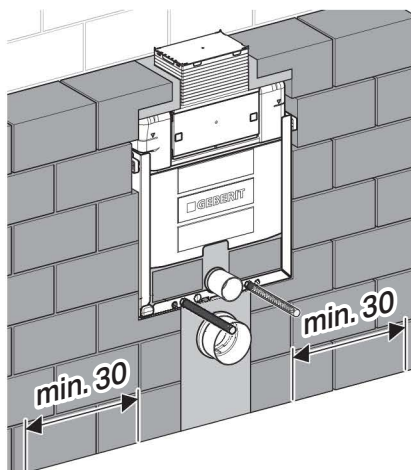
Einbau Geberit Kombifix in Massivbauwand
